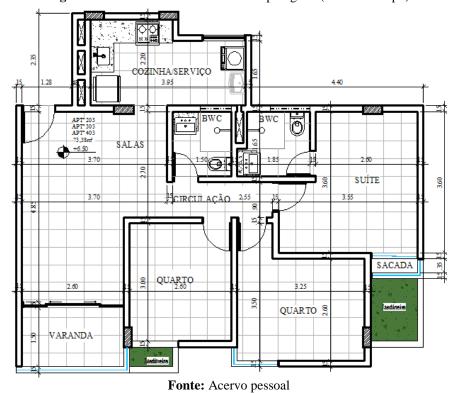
Planta Baixa de UHC de Tipologia 4 (Pavimento tipo)
